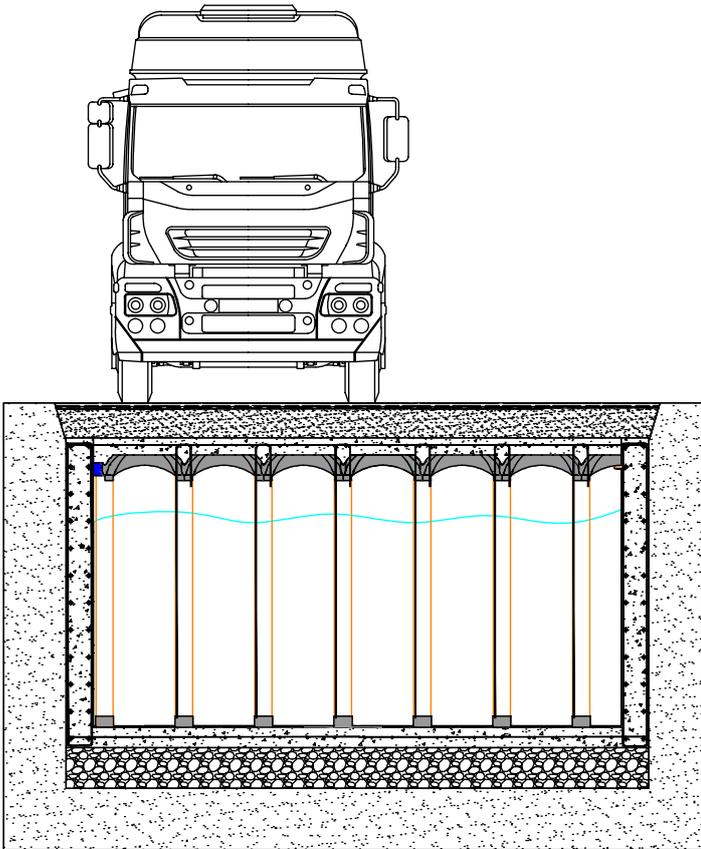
Sezione vasca NUOVO ELEVETOR TANK.
